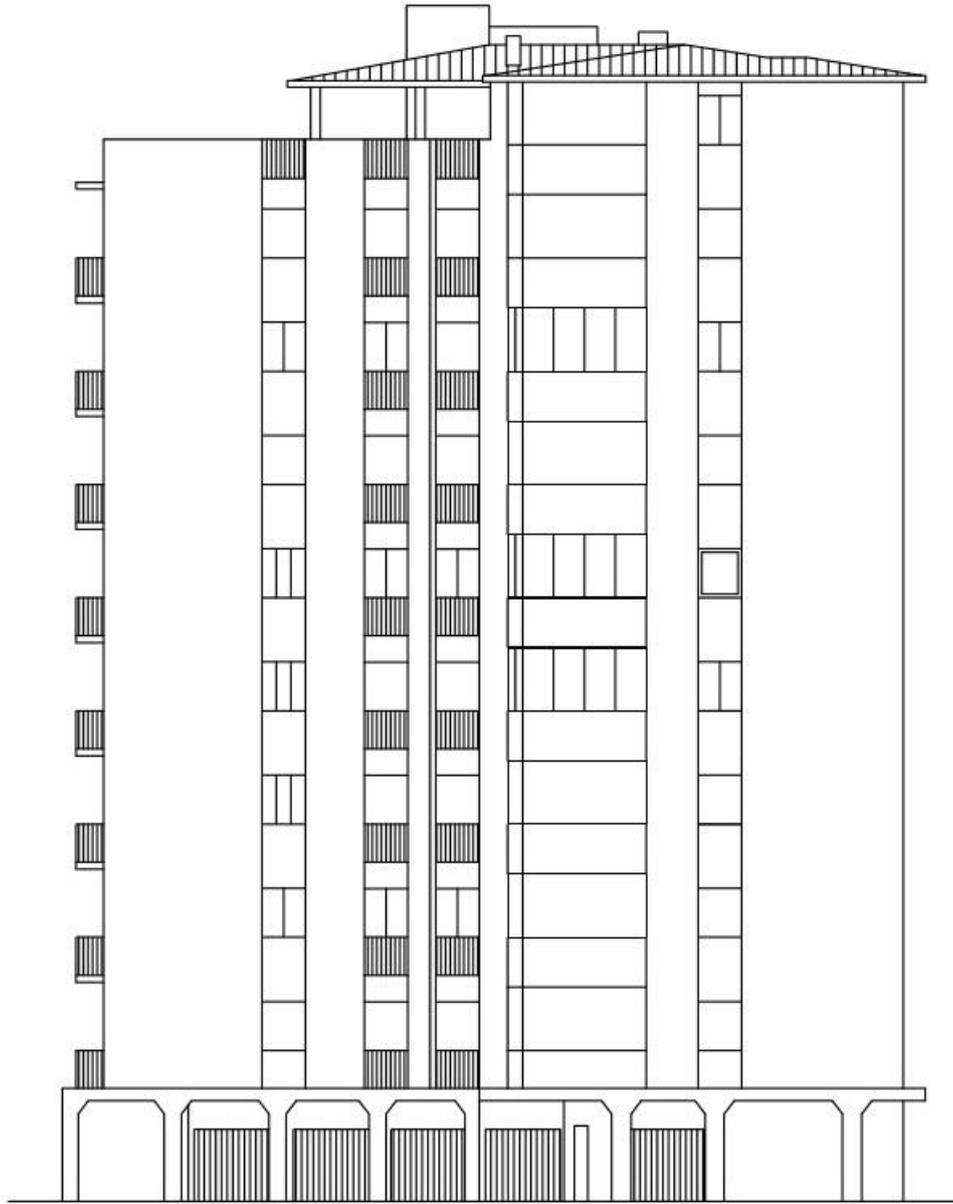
Prospetto Nord, via Brofferio 1. Scala 1:200. Fonte: Ater Padova.
